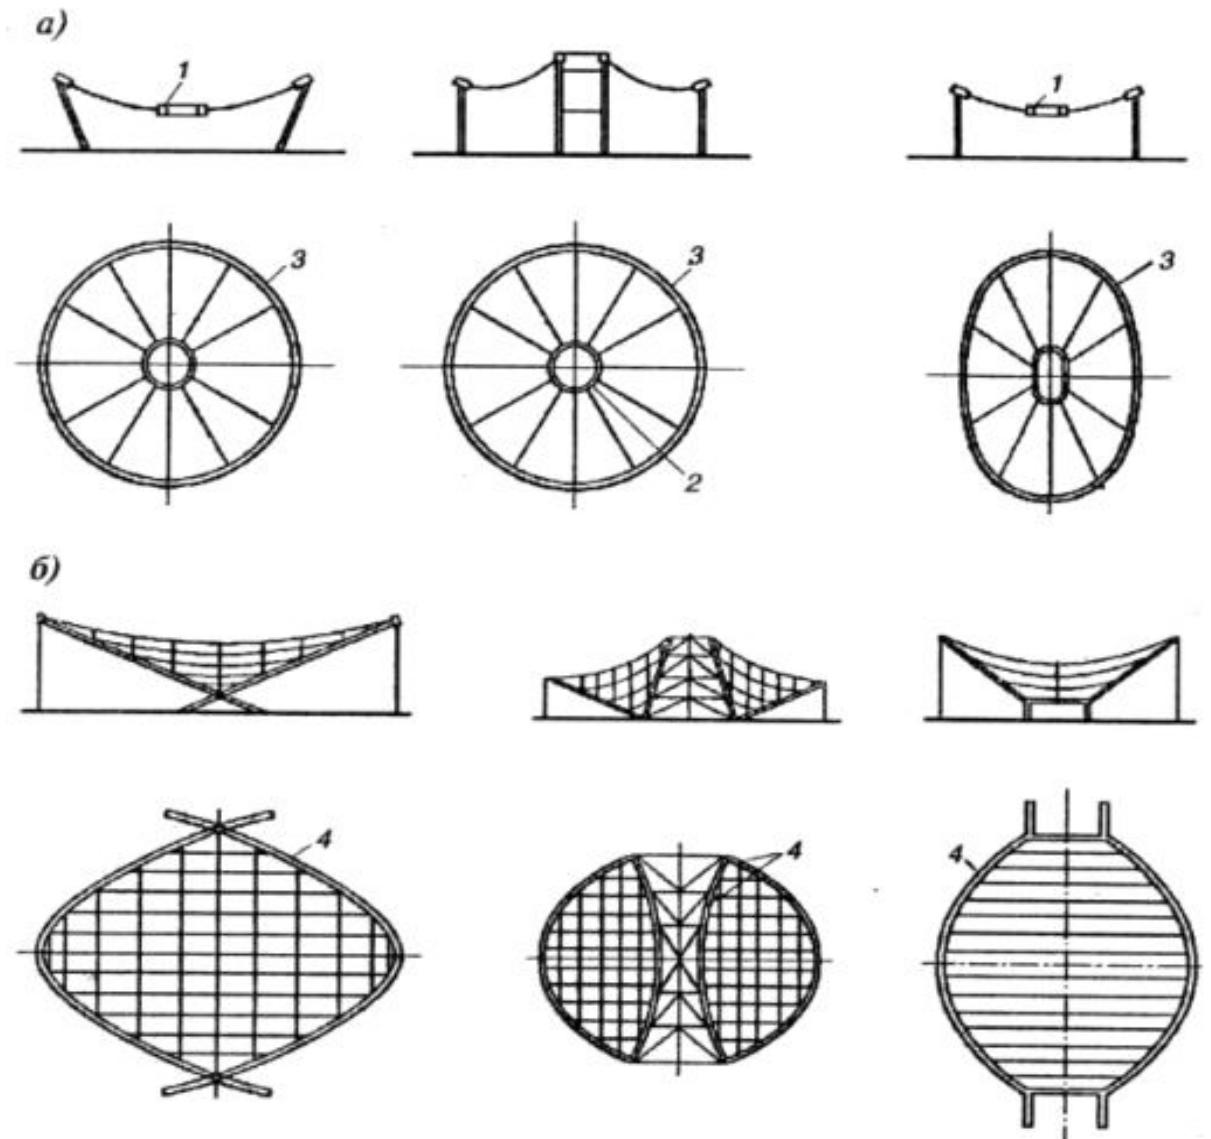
Схемы круглых и арочных опорных конструкций: а – круглых; б – арочных; 1 – внутреннее кольцо; 2 – то же, опорное; 3 – наружное опорное кольцо; 4 – опорные арки
